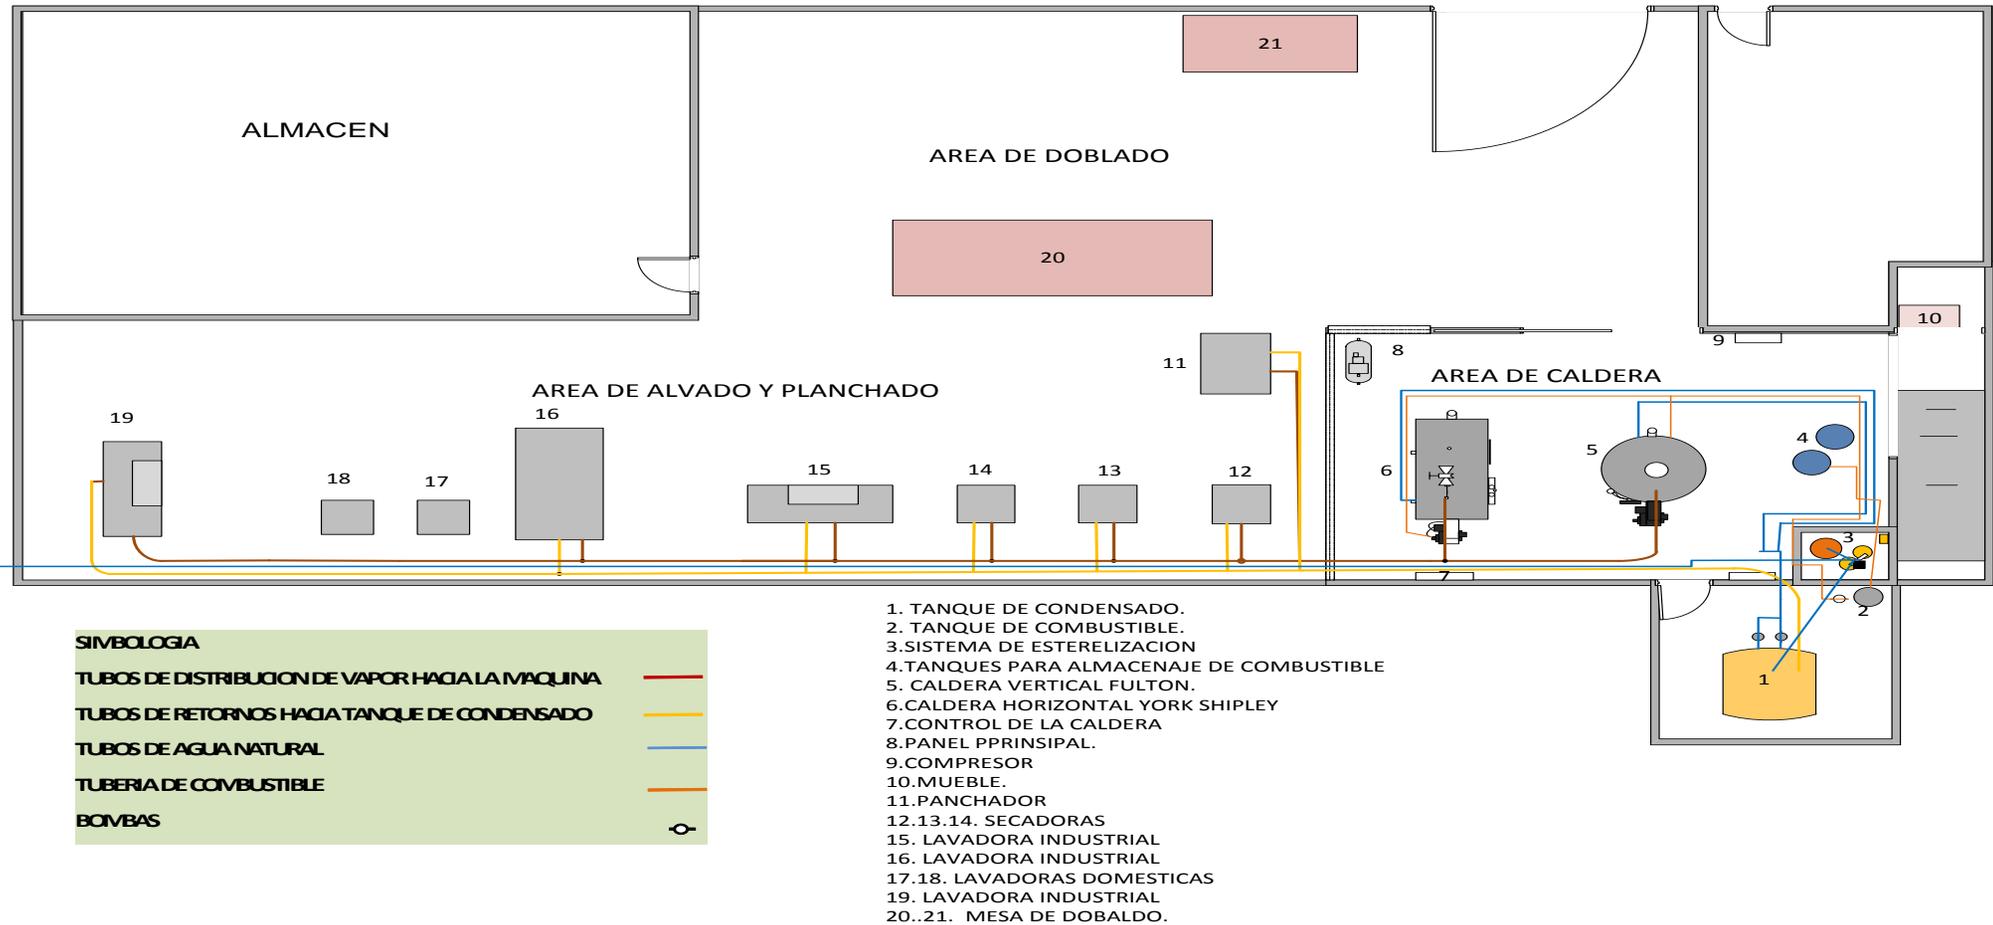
Tuberías de distribución y condensado del sistema de vapor.
